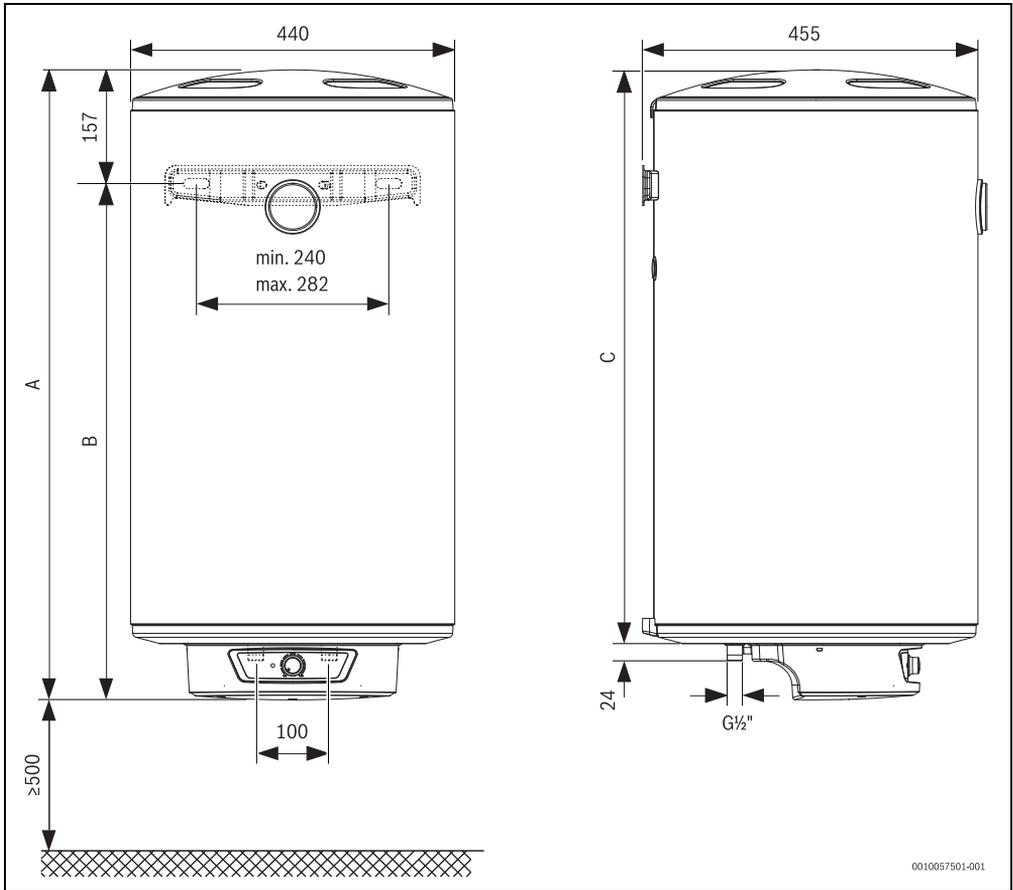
Dimensions en mm (montage mural, installation verticale)
